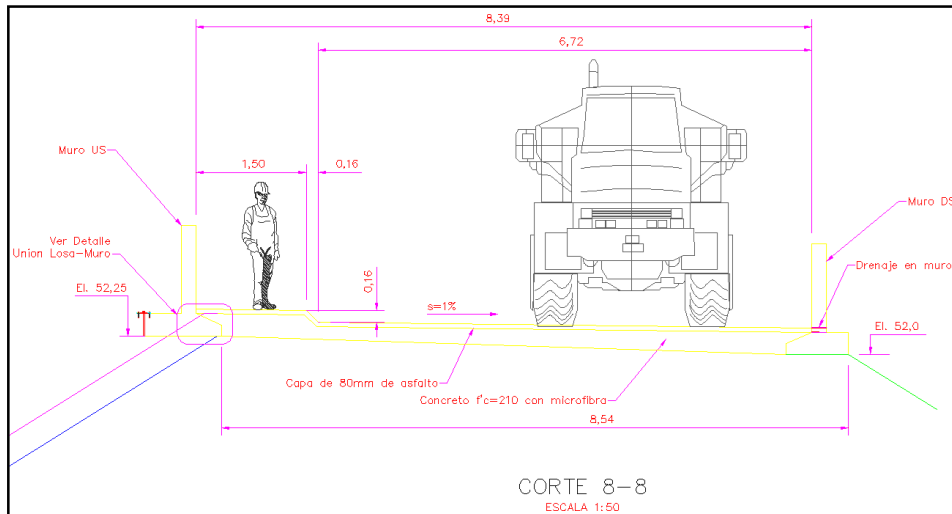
8. Detalle de los parapetos de la presa Paacume
